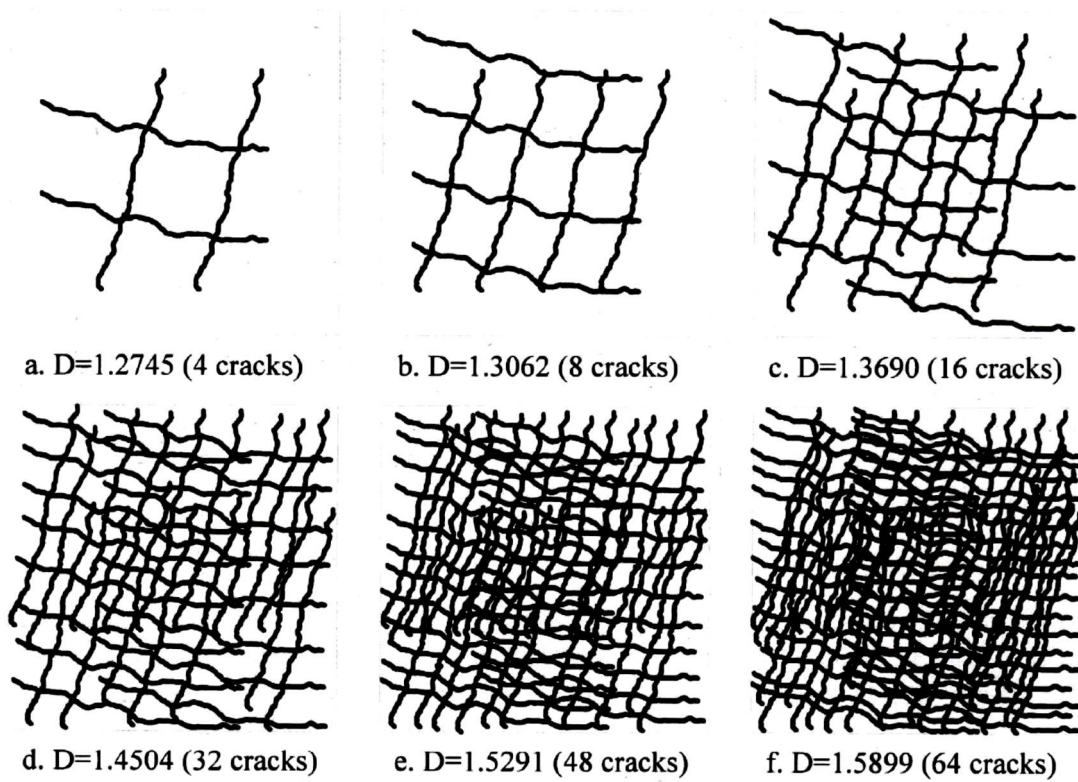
ひび割れ本数別ひび割れモデル図
